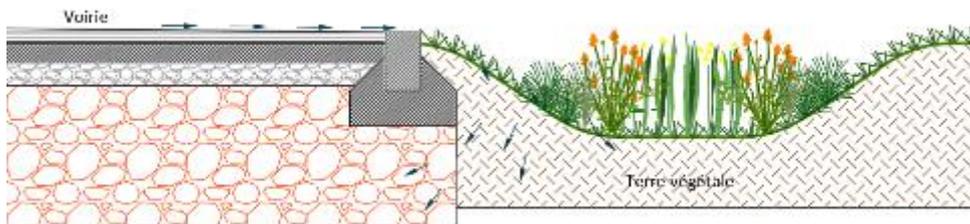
Coupe en travers d'un profil de voirie sur chaussée réservoir et injection par espace vert (IS)
